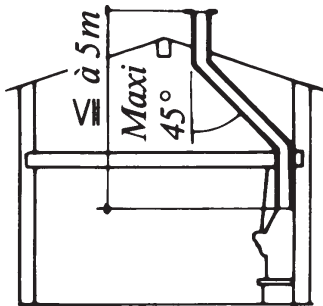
Condotto ventilato in attraversamento di soletta in muratura
